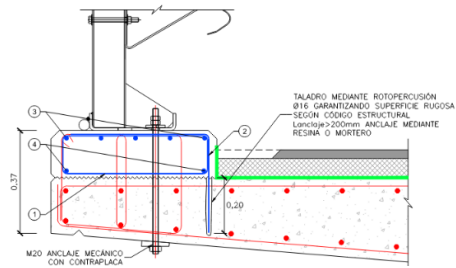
Detalle de acondicionamiento de zócalo para cimentación de pretil.
